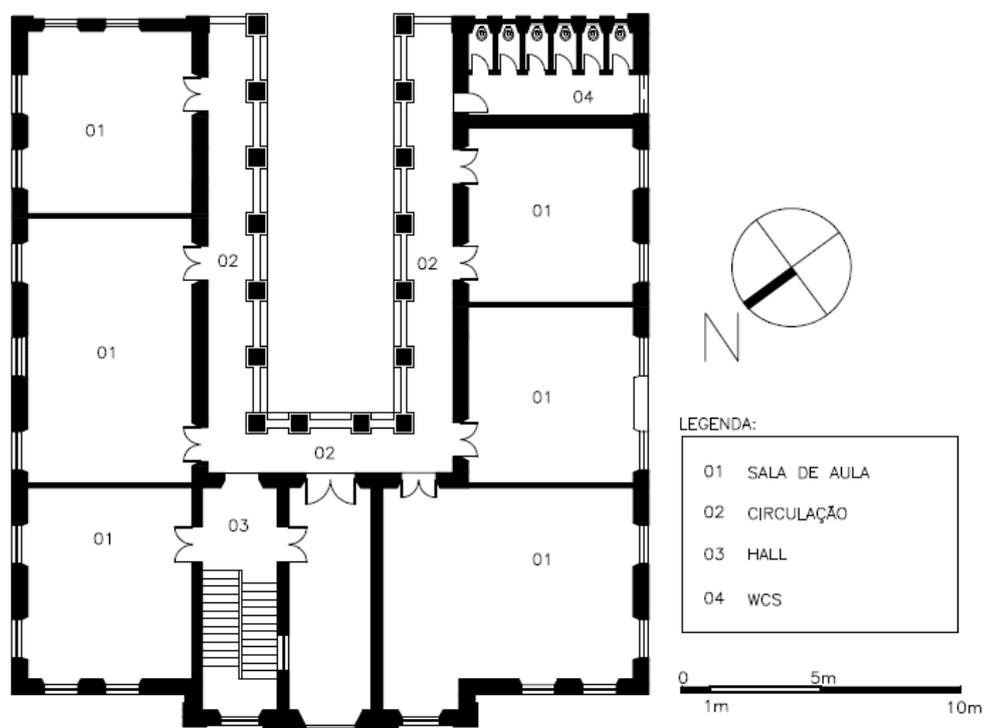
Planta pavimento Superior - Desenho de 1937
